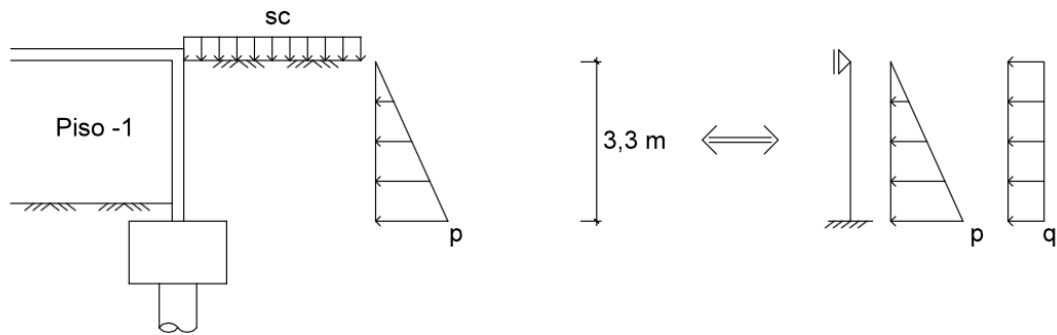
Modelo de cálculo do muro de suporte tendo só em conta a 1ª cave.
